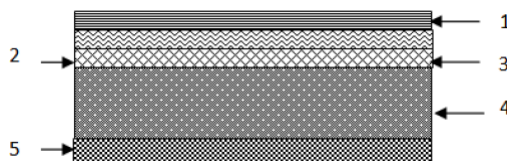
Coupe transversale dans le plancher à dalle pleine
